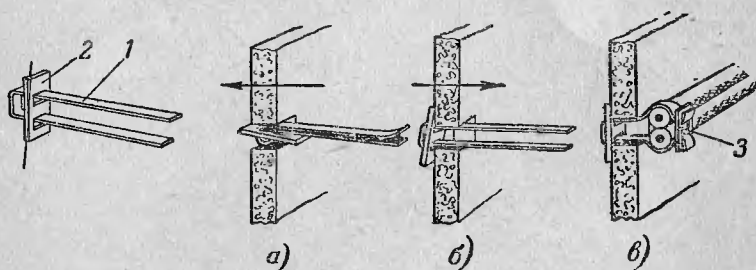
Крепление проводов АПН по сухой штукатурке, выполняемое специальными закрепами.
